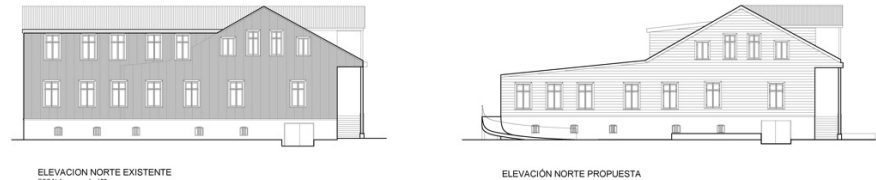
Elevación norte actual y propuesta (fuente: elaboración propia, 2022).
